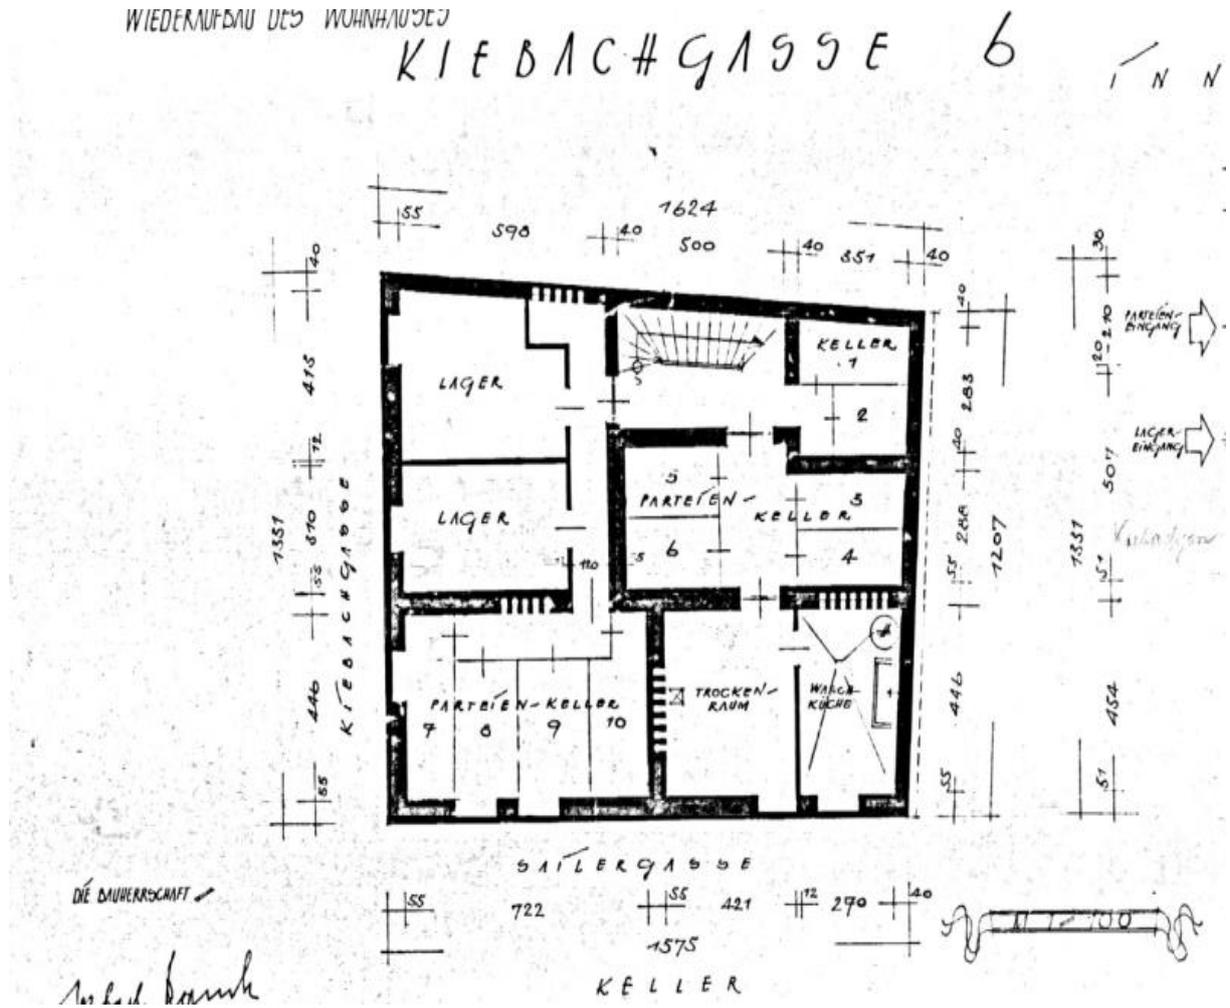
Grundriss aus Einreichplanung Kellergeschoß
